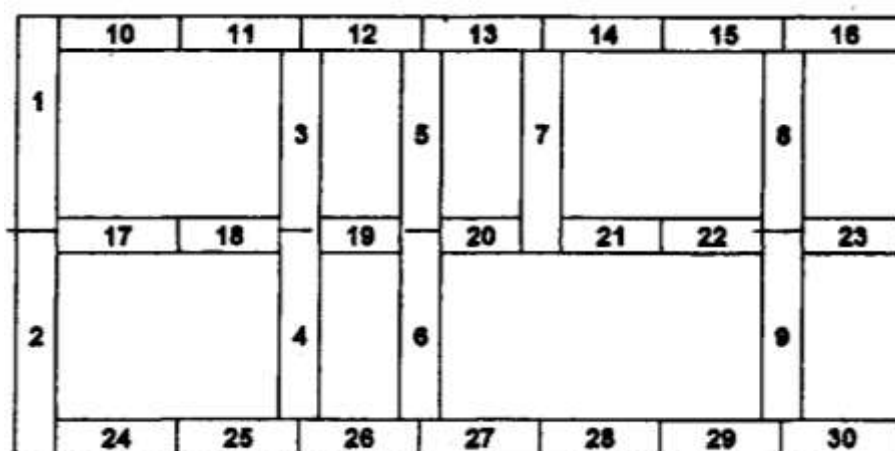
Схема монтажу із поперечними несучими стінами:
